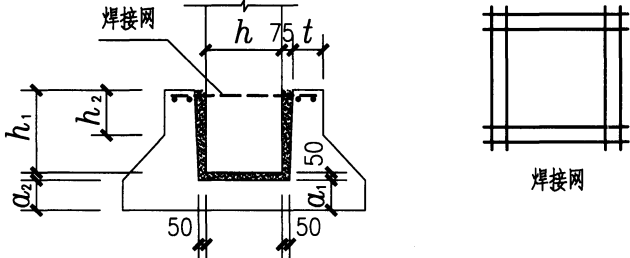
预制钢筋混凝土柱与杯口基础的连接示意
